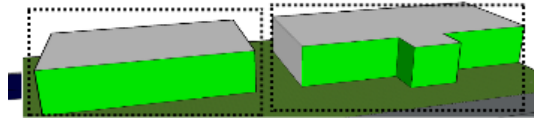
Fasad Bangunan Stasiun Kereta Api Binjai
